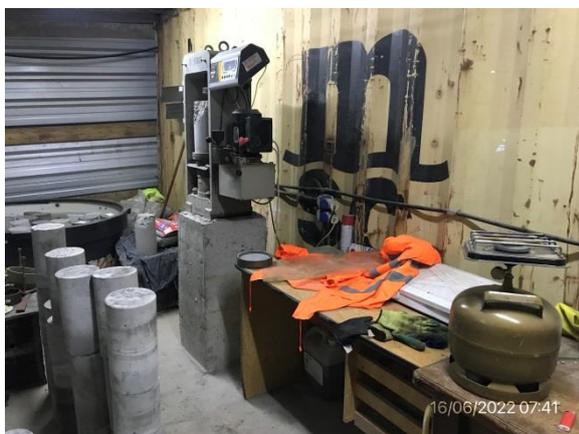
P09, Obrador principal. Laboratorio de hormigón.
